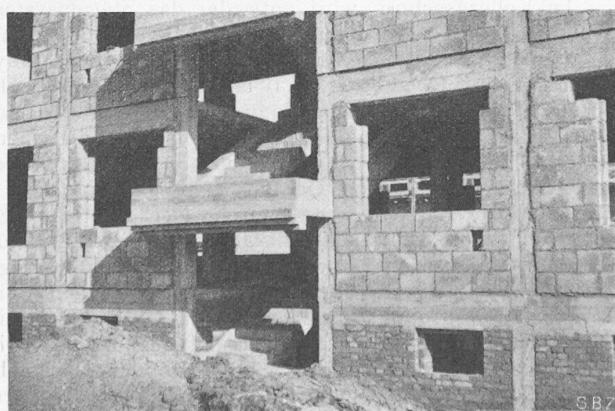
Ausfachung des Eisenbeton-Skelettbau; Treppenpodest.
